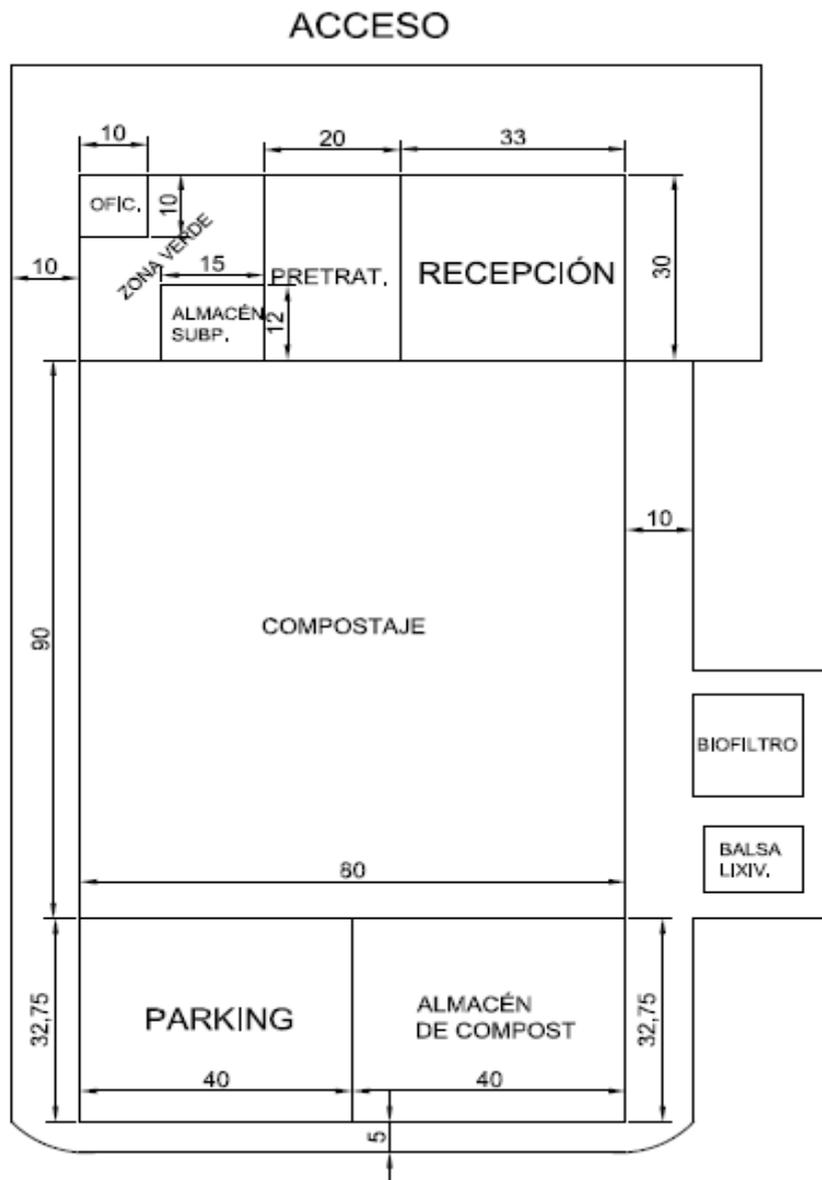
Plano de la parcela con distribución en planta. Fuente: Elaboración propia
